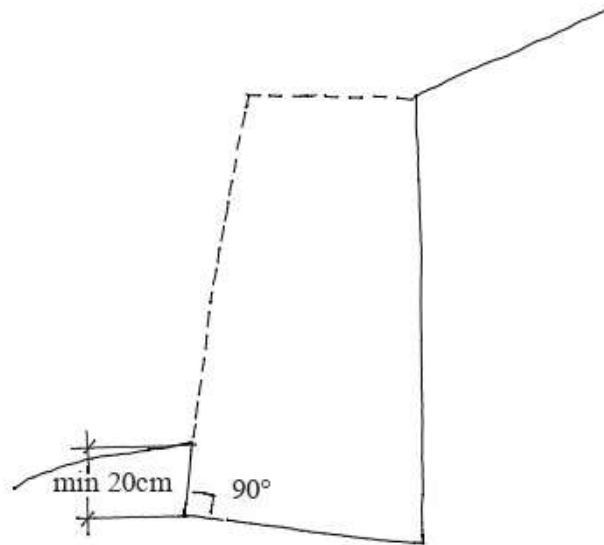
Lo scavo per la fondazione e la profondità minima nel terreno
